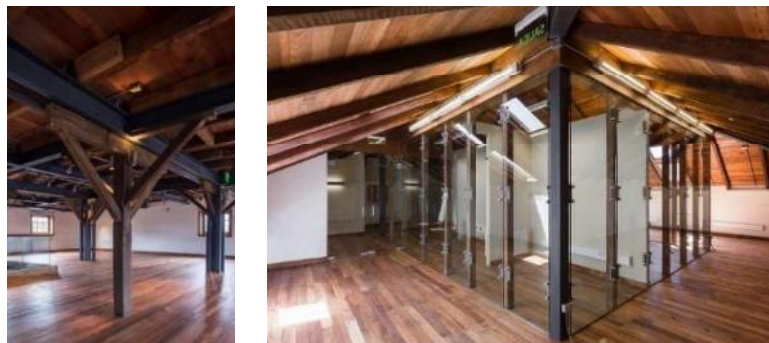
Fotografías de vigas y columnas reforzadas con estructuras metálicas.
